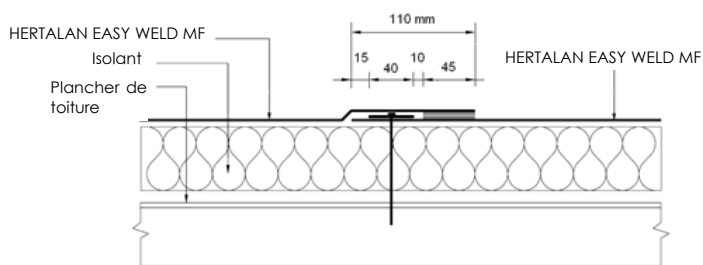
Joint longitudinal HERTALAN EASY WELD MF
